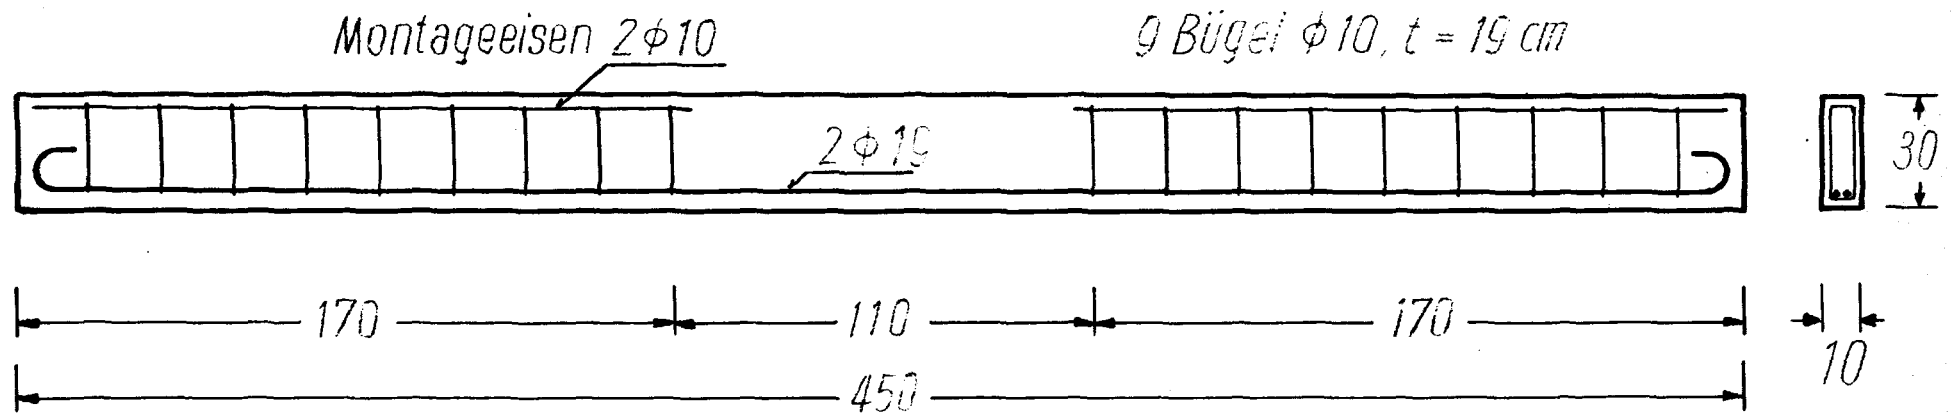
Bewehrung der Schwerbetonbalken, wenn $\mu = 2\%$ gewählt wurde
